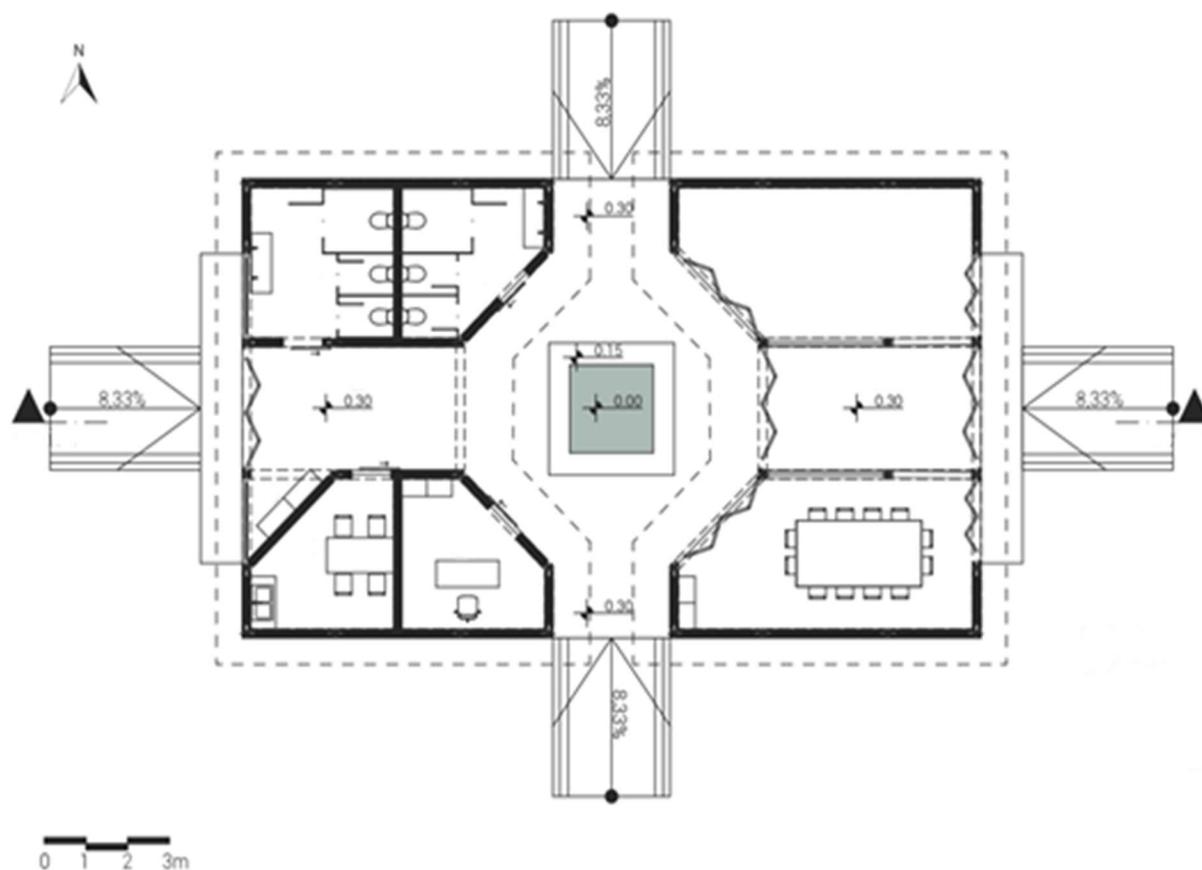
Planta Baixa em archicad. FONTE: Elaborada pelas autoras.
